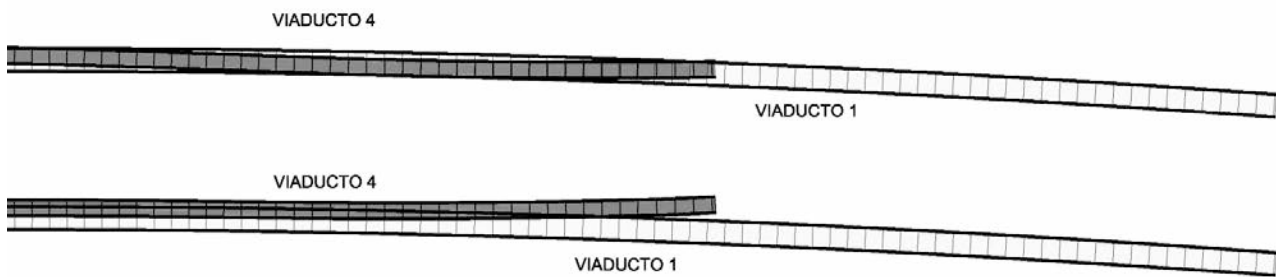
Posición en planta viaducto V4 antes y después de la maniobra de ripado
